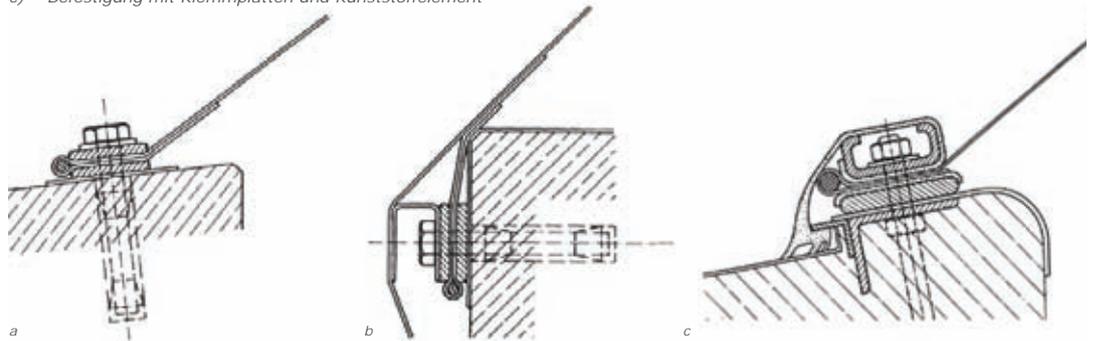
Befestigung biegesteifer Rand auf Holz - nicht spannbar
